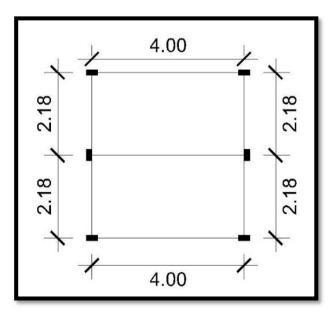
Modulación estructural bloque 05 hab. Simple.
